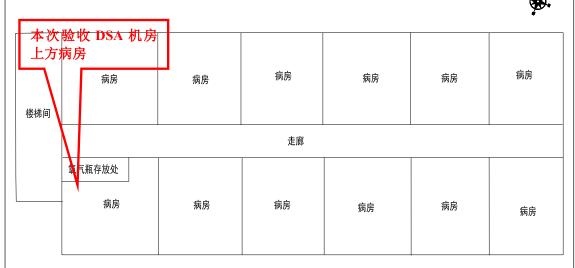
安徽中医药大学第一附属医院综合楼二层平面布置图
